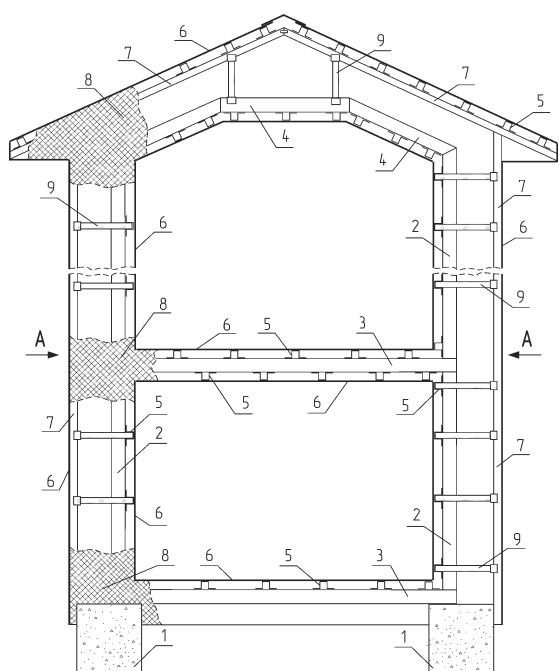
Поперечный разрез здания: 1 – фундамент; 2 – колонна внутреннего каркаса; 3 – ригель внутреннего каркаса; 4 – балка перекрытия; 5 – гнутый профиль; 6 – лист опалубки; 7 – внешний каркас; 8 – лёгкий бетон; 9 – временный фиксатор.
